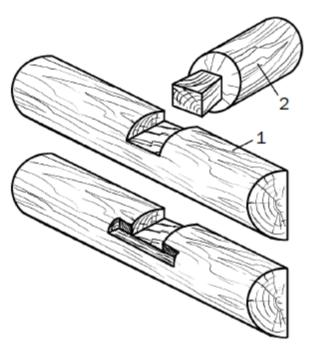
Выполнение соединения «ласточкин хвост»: 1 — наружная стена; 2 — внутренняя стена Для соединения балок чердачного и междуэтажного перекрытия используют врубку под названием «глухой сковородень» (рис. 62).
